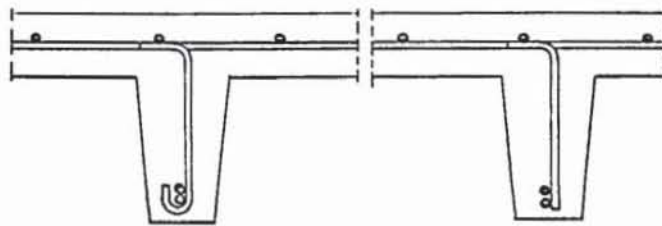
Matte mit Schubleitern, Bewehrung einer Rippendecke
